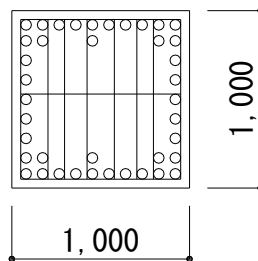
鉄筋コンクリート柱の配筋図 (1階, 4/C通り) (単位: mm)
